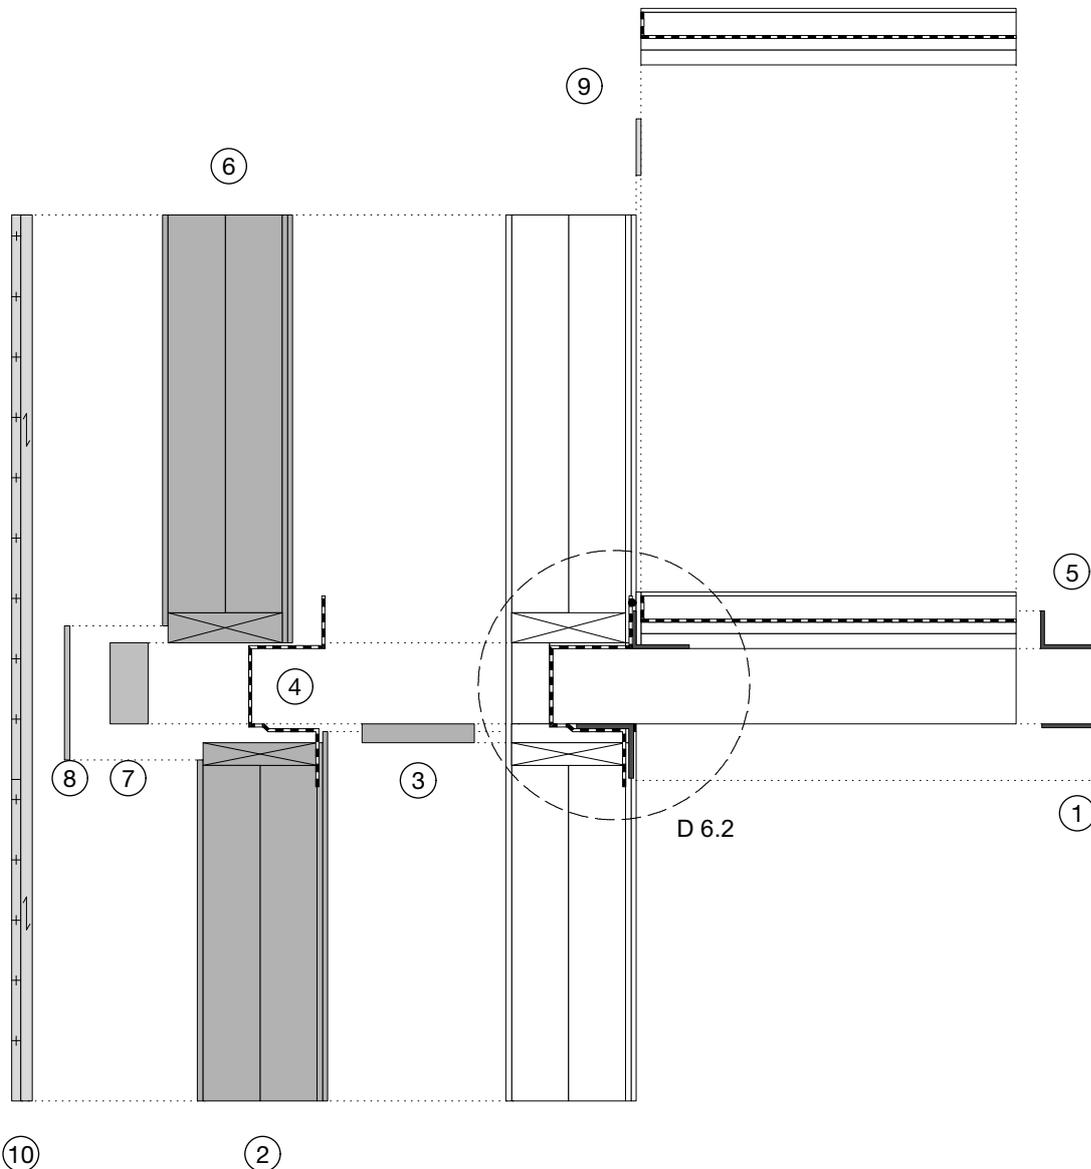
Montager Reihenfolge - Anschluss Geschossdecke - Außenwand, eingestellt
